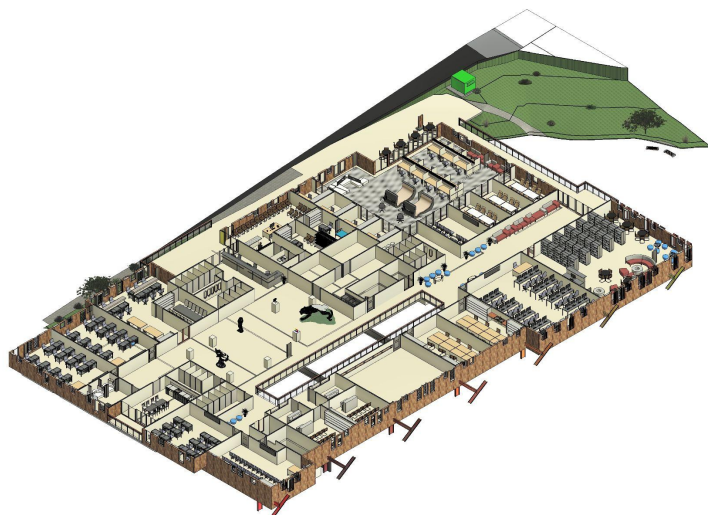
Vista 3D, planta nivel 2 Fuente propia.
